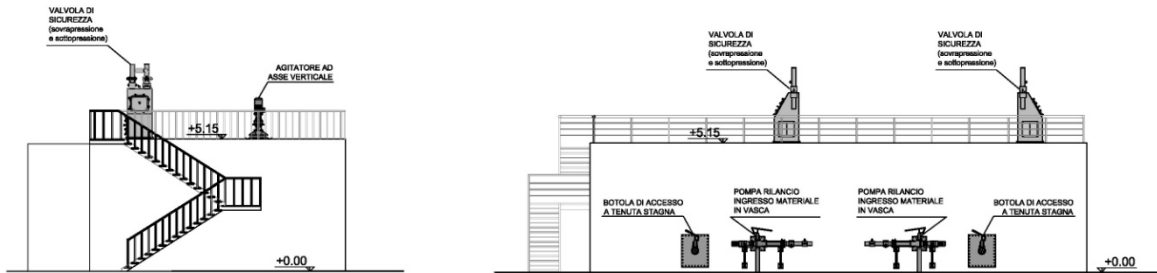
Prospetti delle vasche di precarico – a sinistra prospetto sud a destra prospetto est (retro delle vasche)
